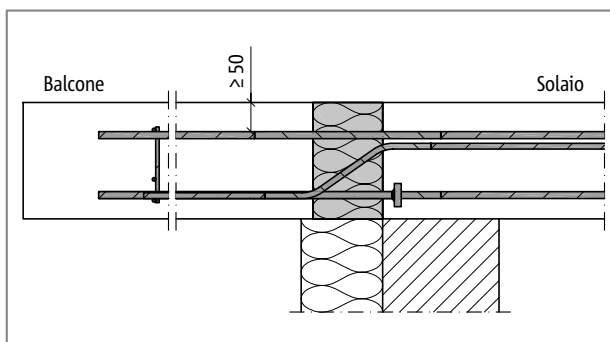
Schöck Isokorb® tipo EXT-CV50: raccordo con sistema di isolamento a cappotto (WDVS)
